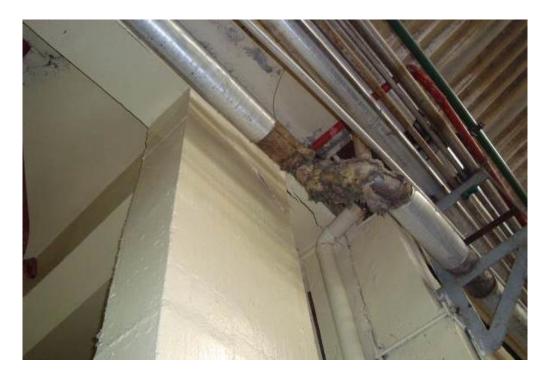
Vista de danos generalizados em viga junto a laje abaixo da "cozinha".
